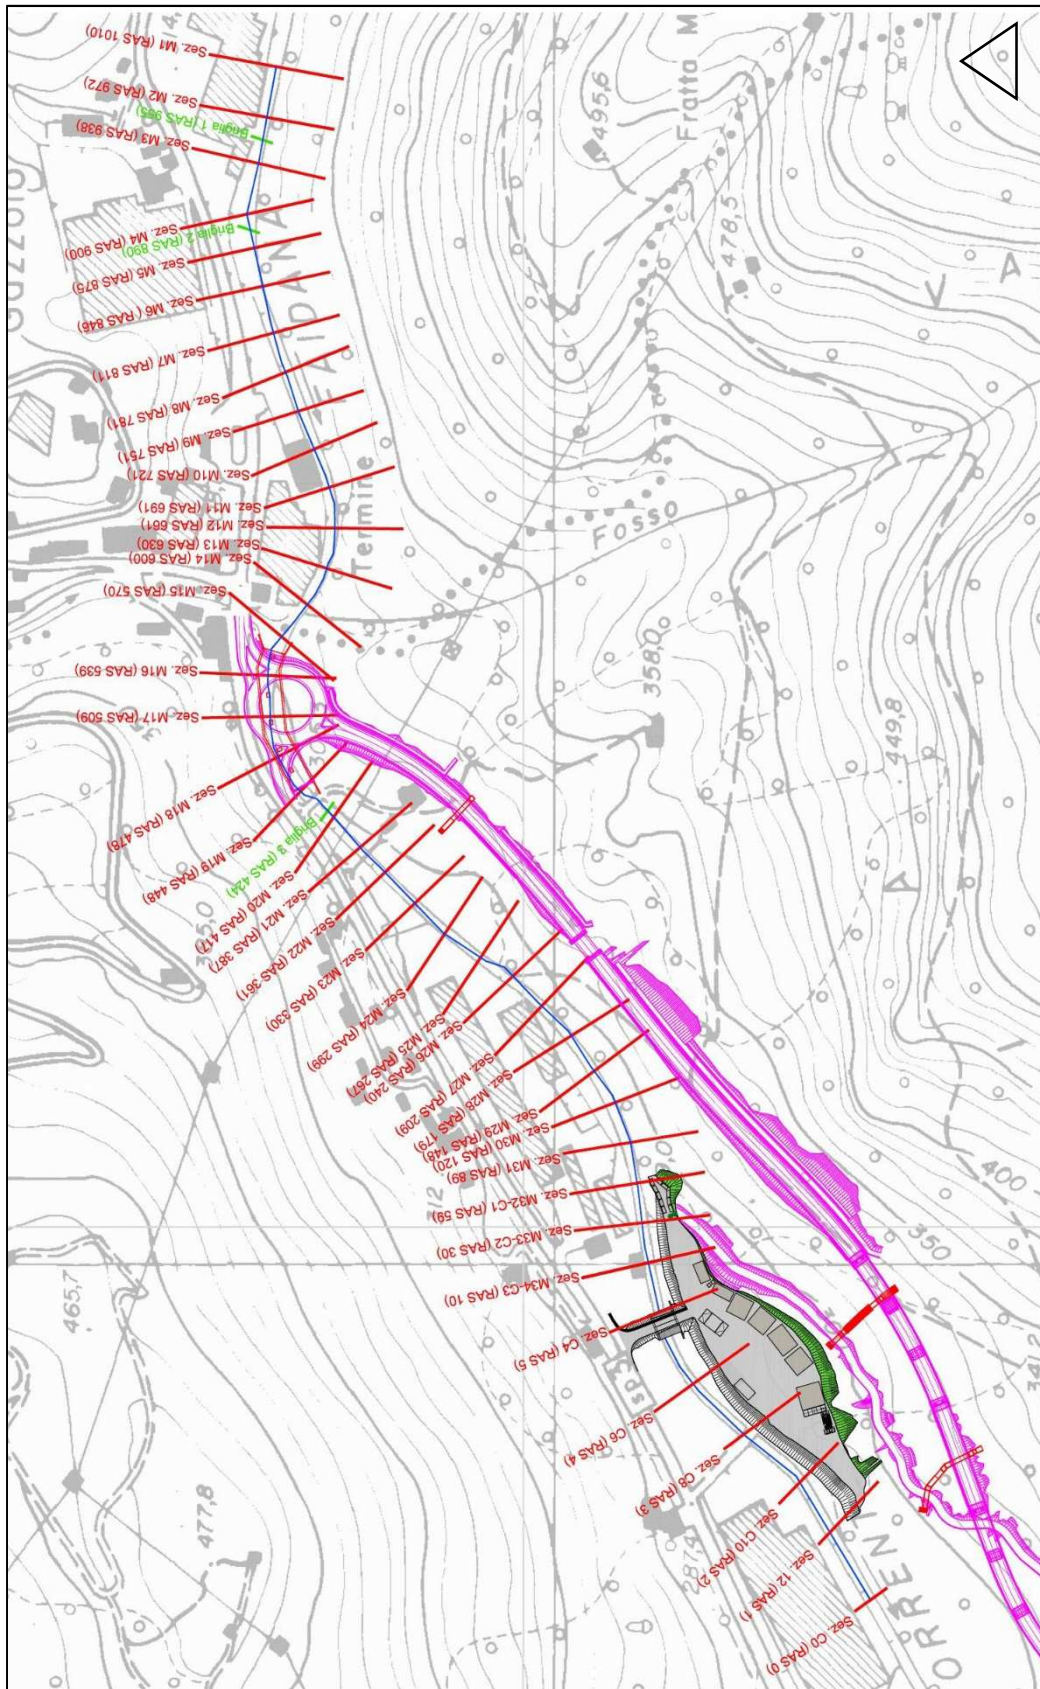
Torrente Faidana - Planimetria tratto analizzato e indicazione sezioni RAS
